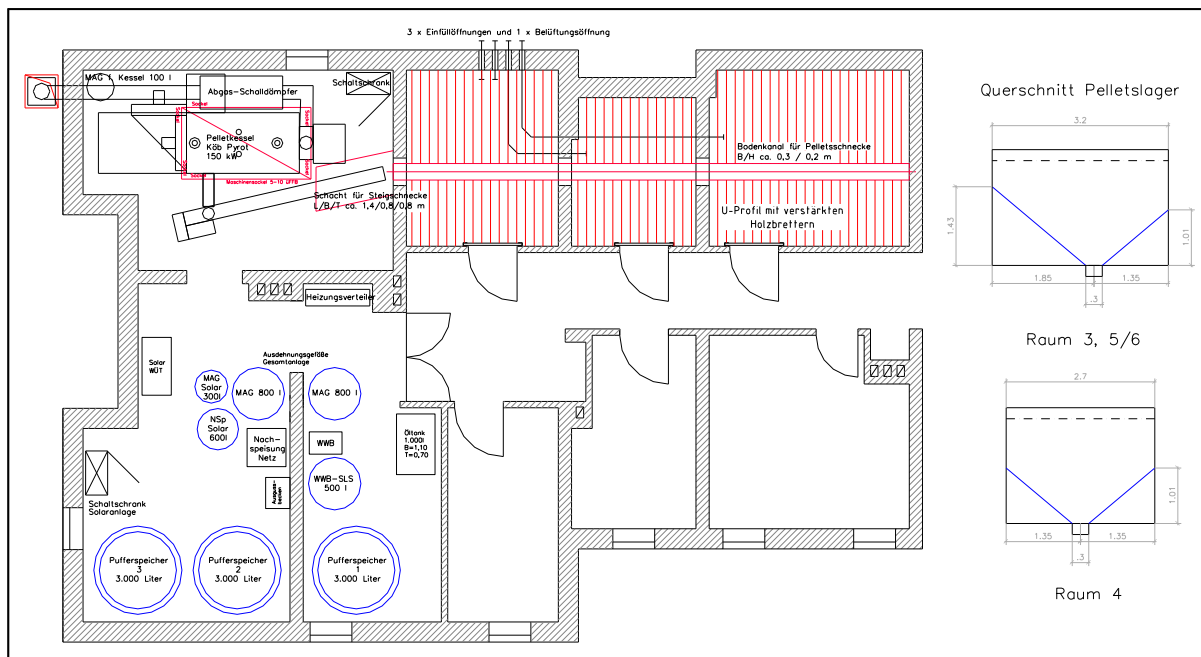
Ausschnitt Grundriss Kellergeschoss Mehrfamilien-Wohngebäude, Magdeburger Straße 2 und 4, Hannover
